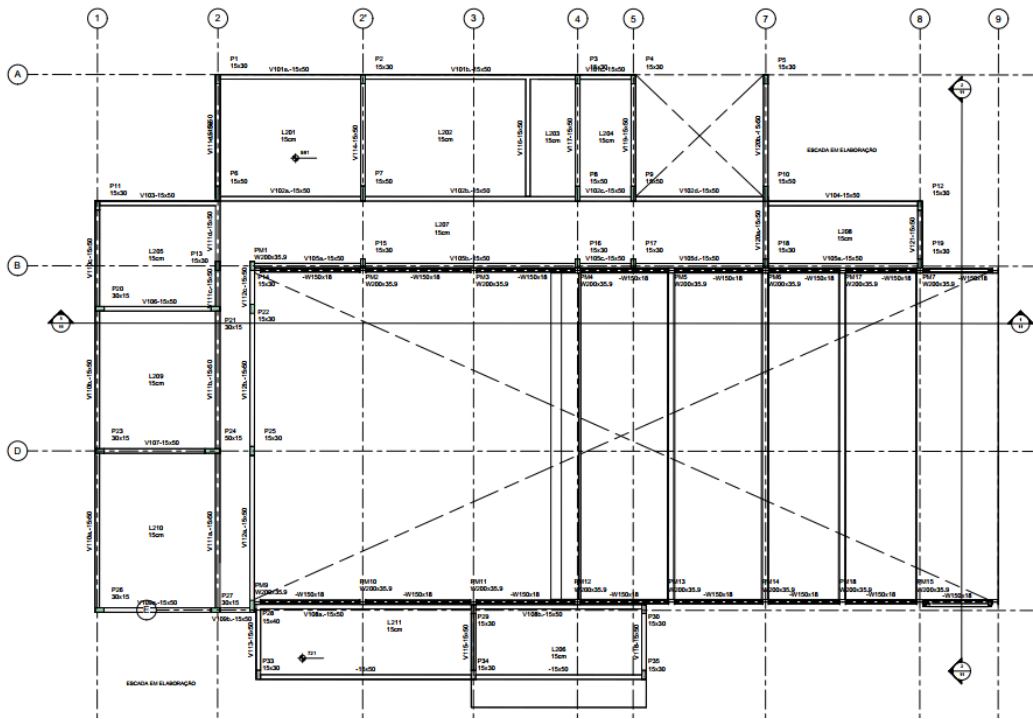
Planta da estrutura metálica e de concreto do 1º pavimento do anexo 2 [dimensões em mm; Fonte: Desenho Cerne 0001_07_ET_RE_1007_00].
